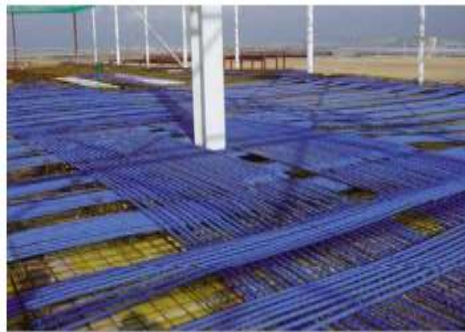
Colocação de bandas de monocordões auto embainhados em lajes
